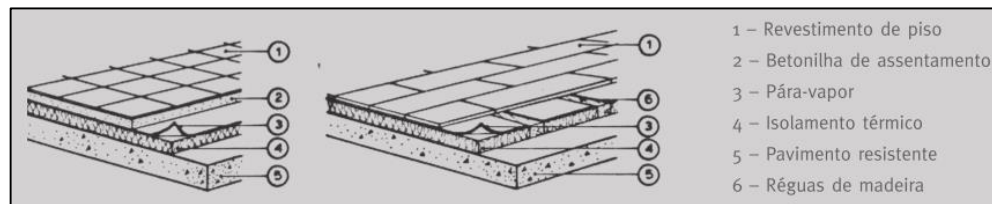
Pavimento sobre espaço exterior ou não aquecido – Isolamento térmico superior[5]
